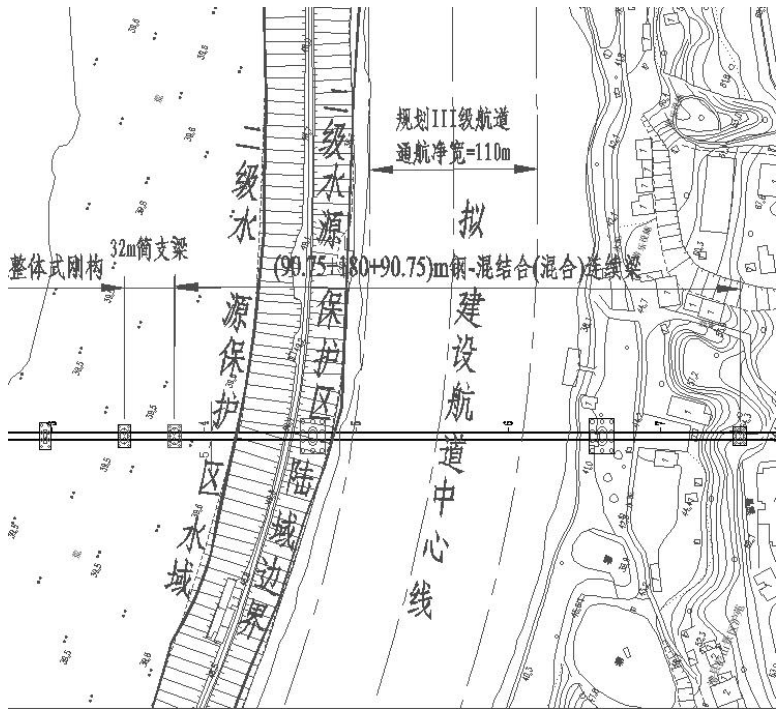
艳洲桥位方案跨越澧水航道桥址平面图
